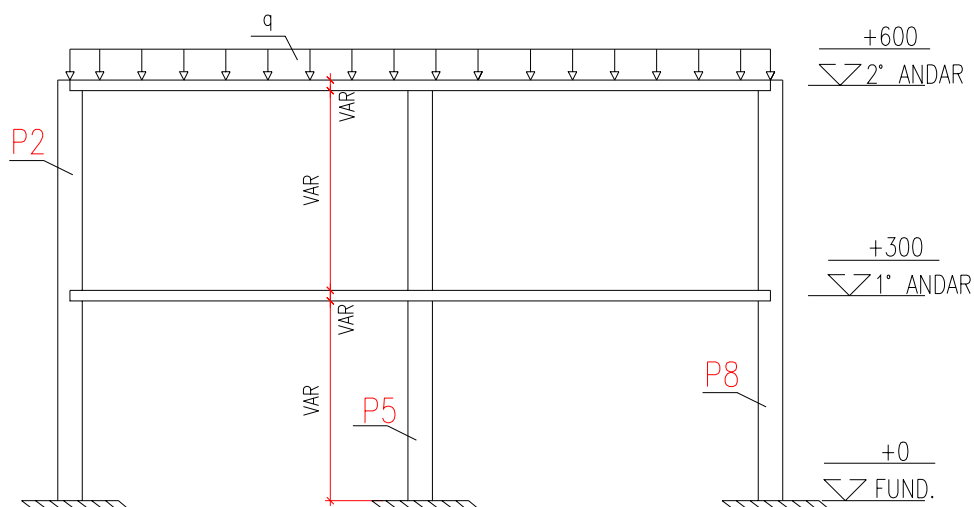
Estrutura 2 do Modelo LAJE-EVOL
